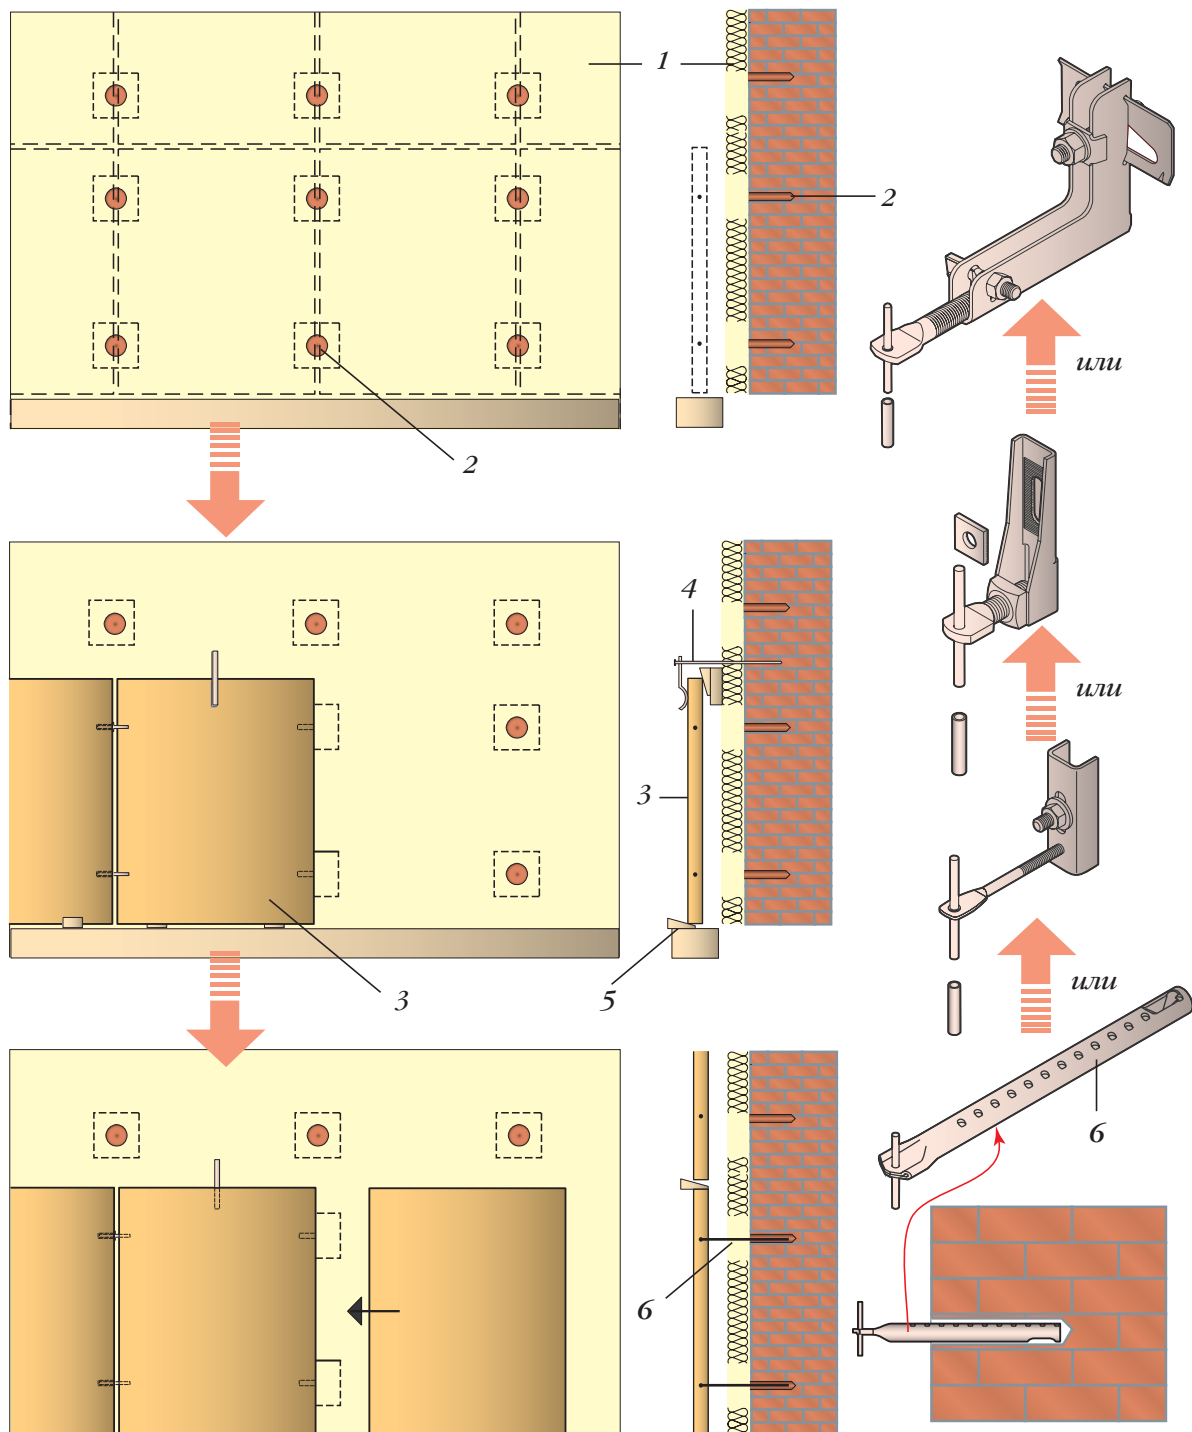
Пример установки каменных облицовочных плит с помощью сертифицированных крюков промышленного изготовления: 1 — утепление стены; 2 — просверленные отверстия под крюки (анкеры); 3 — каменная облицовочная плита; 4 — временное крепление плиты; 5 — деревянные клинья; 6 — крепежные крюки
